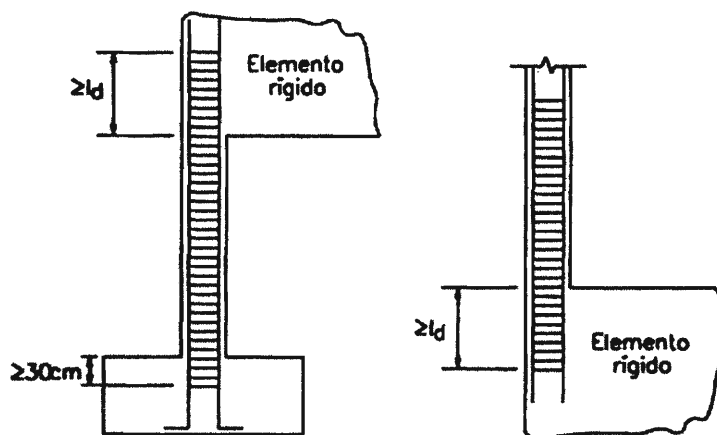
Refuerzo transversal en la unión columna-elemento rígido
